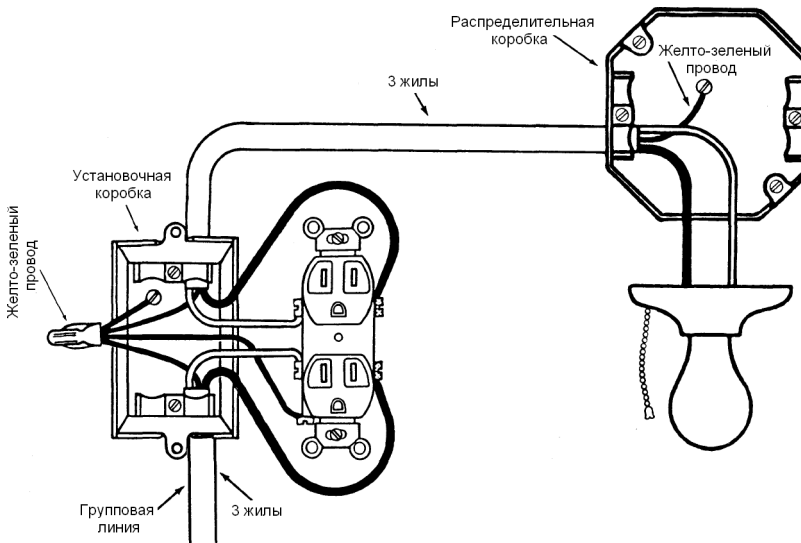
Элемент осветительной сети (использование розетки для соединения проводов)
